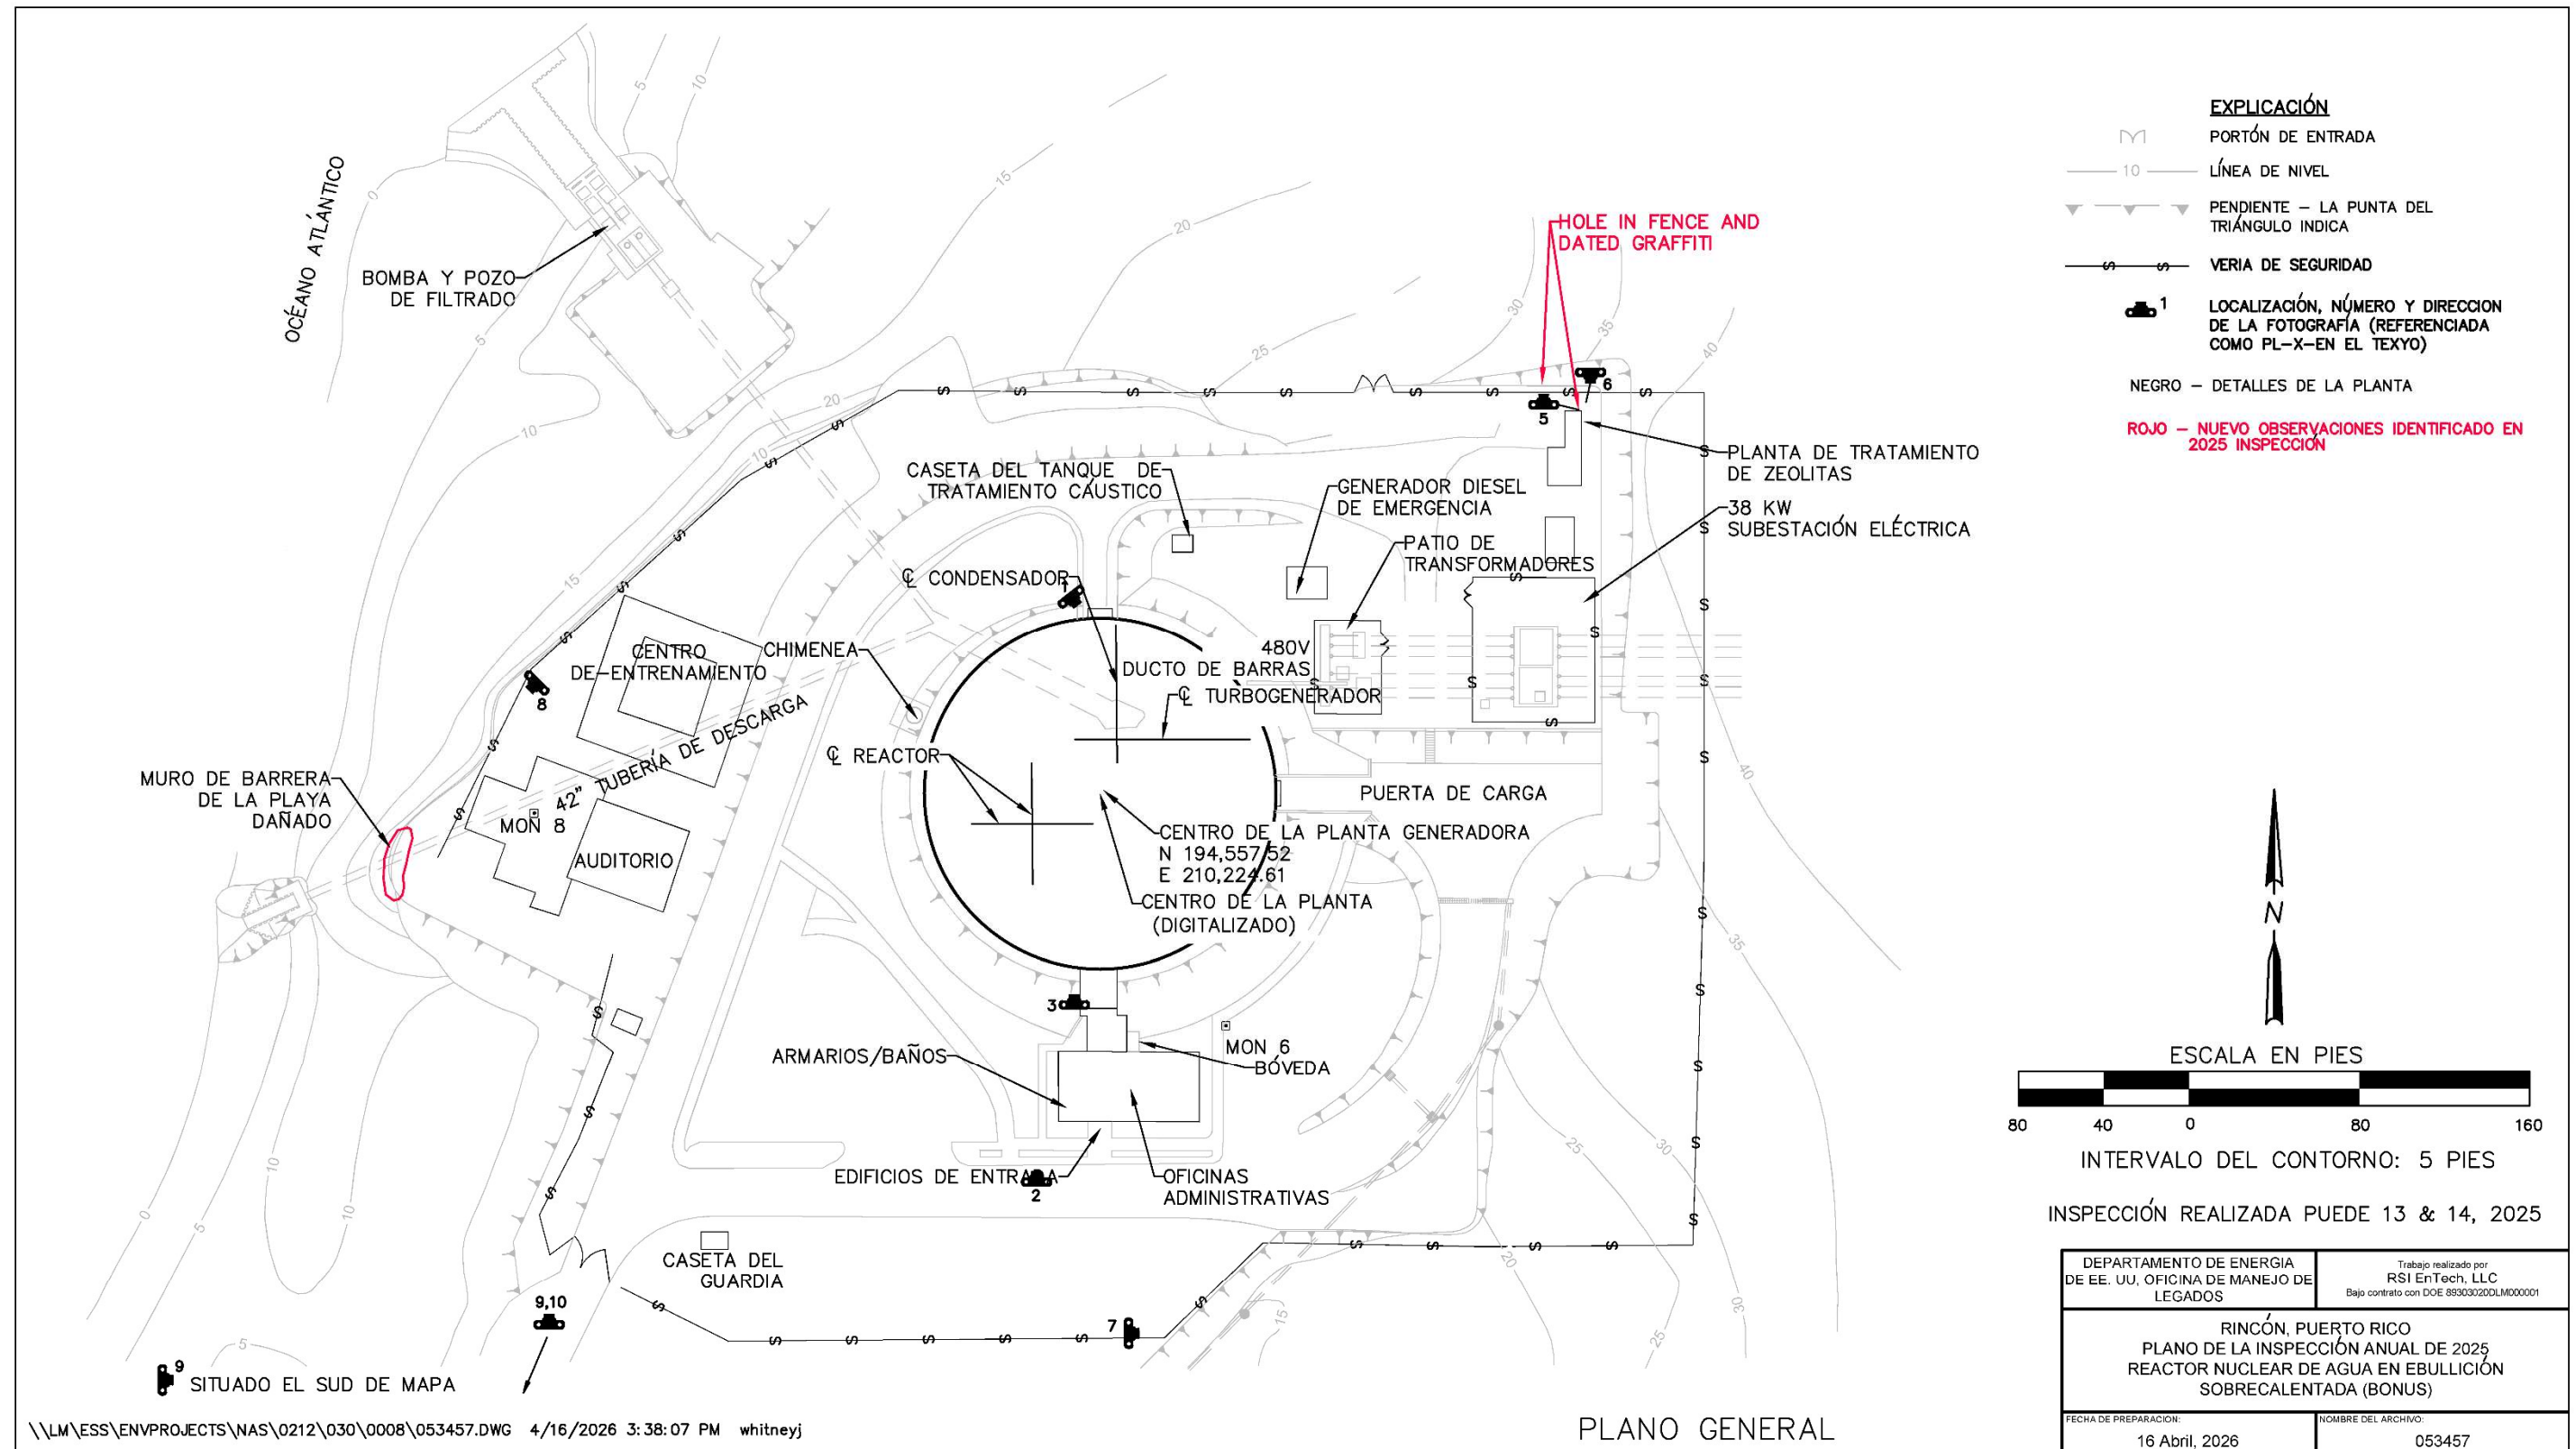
Plano general, Inspección anual de 2025 de la planta BONUS en Rincón, Puerto Rico
